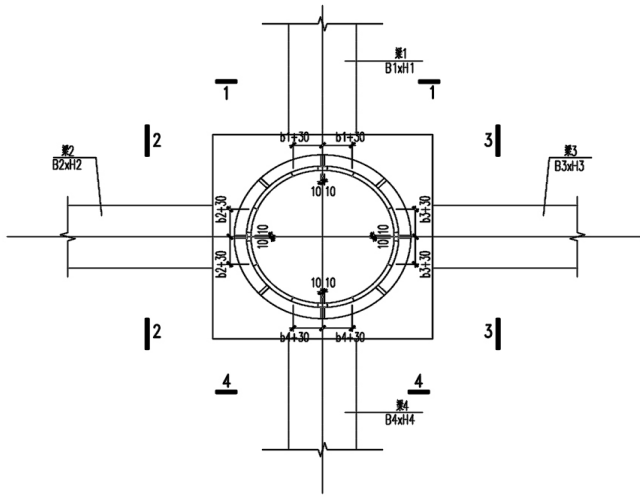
典型钢管混凝土叠合柱梁柱节点构造示意图
